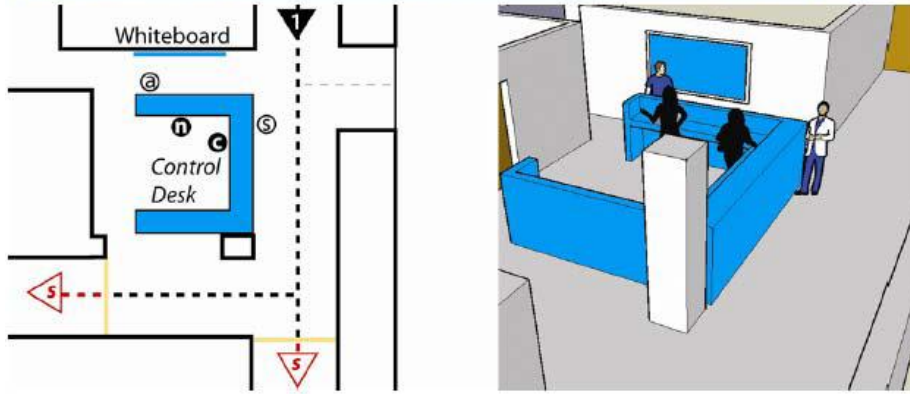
مسقط أفقي للممر المعقم
